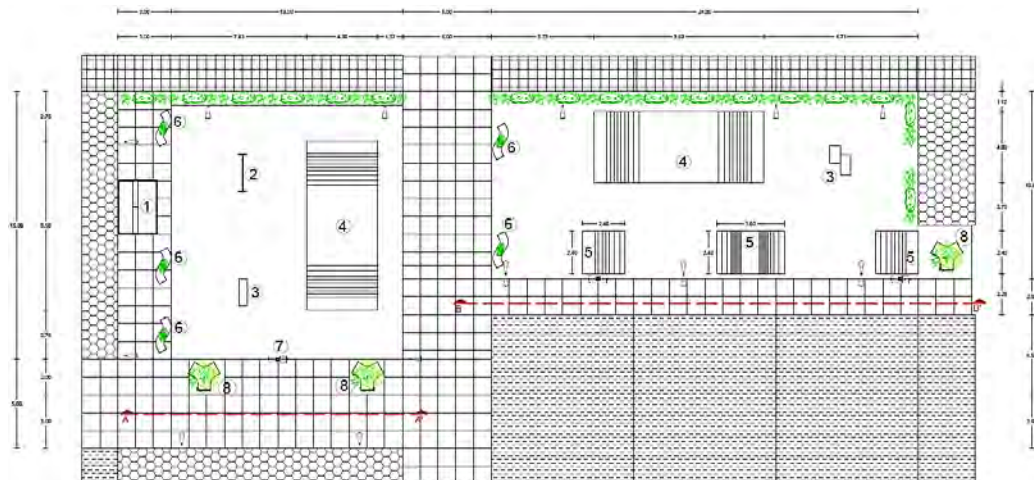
Planta arquitectónica de la plaza 5. Se muestra la disposición del mobiliario utilizado, además de los cambios de pavimentos utilizados.
